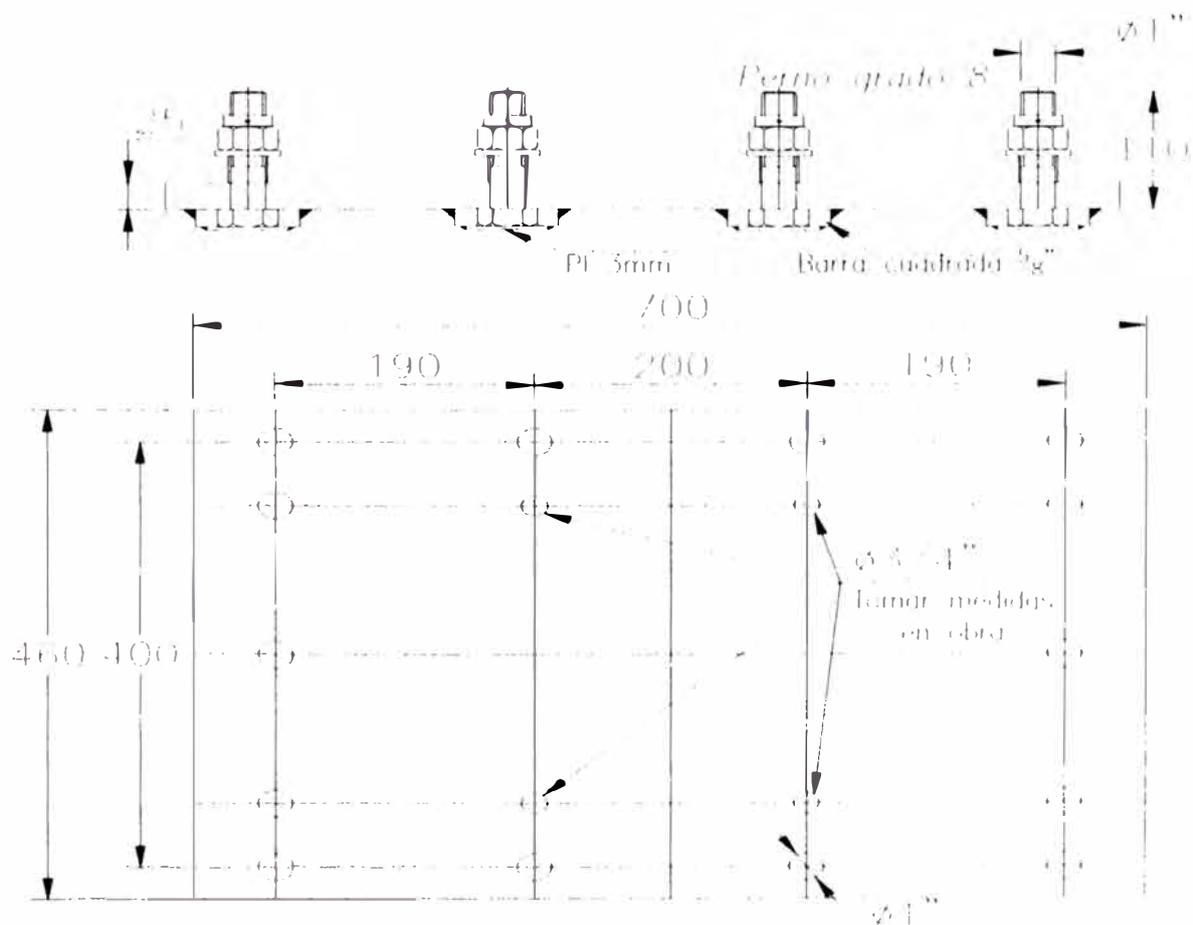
Vistas de la placa soporte de la nave estructural.
